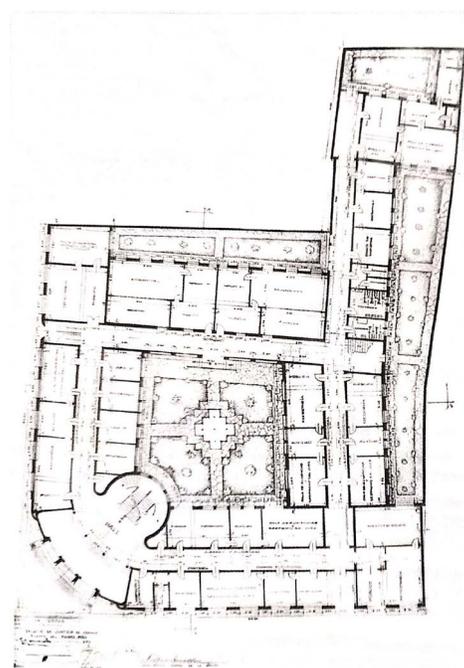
Planta nivel de acceso. Germán Tejeiro (1944). Fuente: Niño Murcia (1999) página 124
